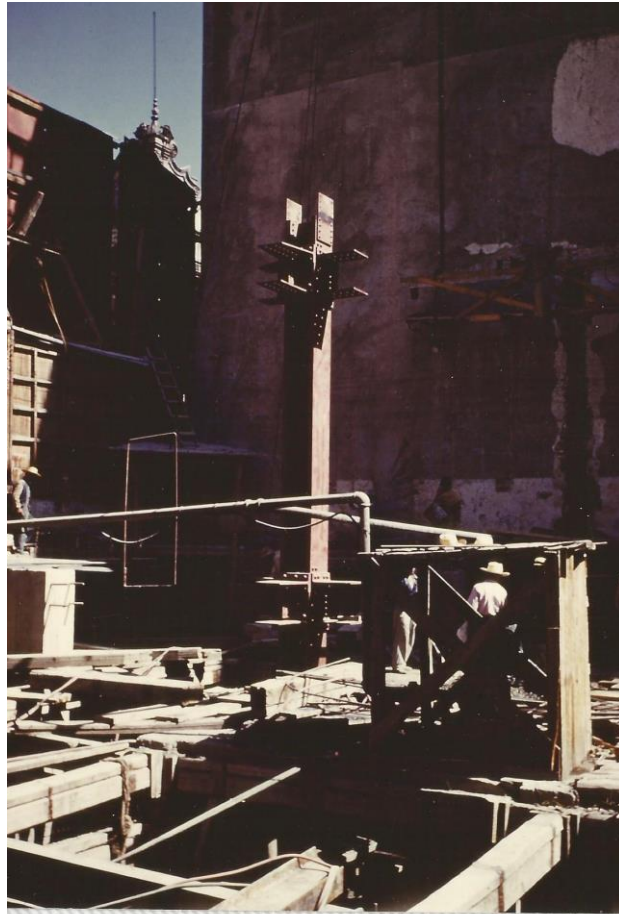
MONTAJE DE LAS PRIMERAS COLUMNAS.
